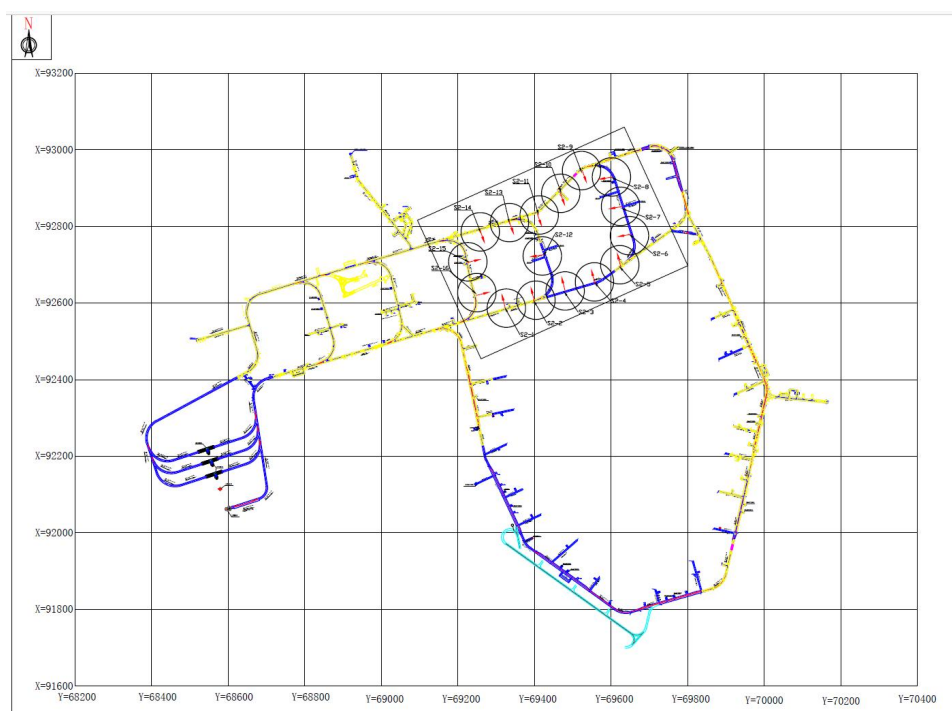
560 m 中段地声智能传感器布设示意图
